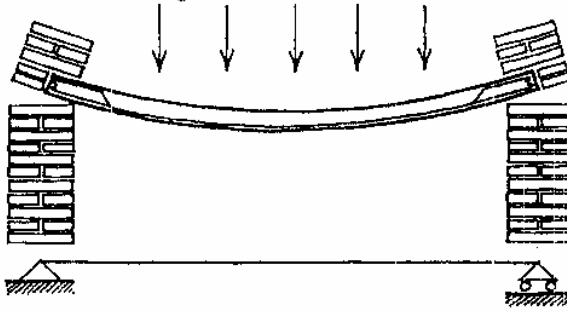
Vinculación entre losa de hormigón y mampostería.
